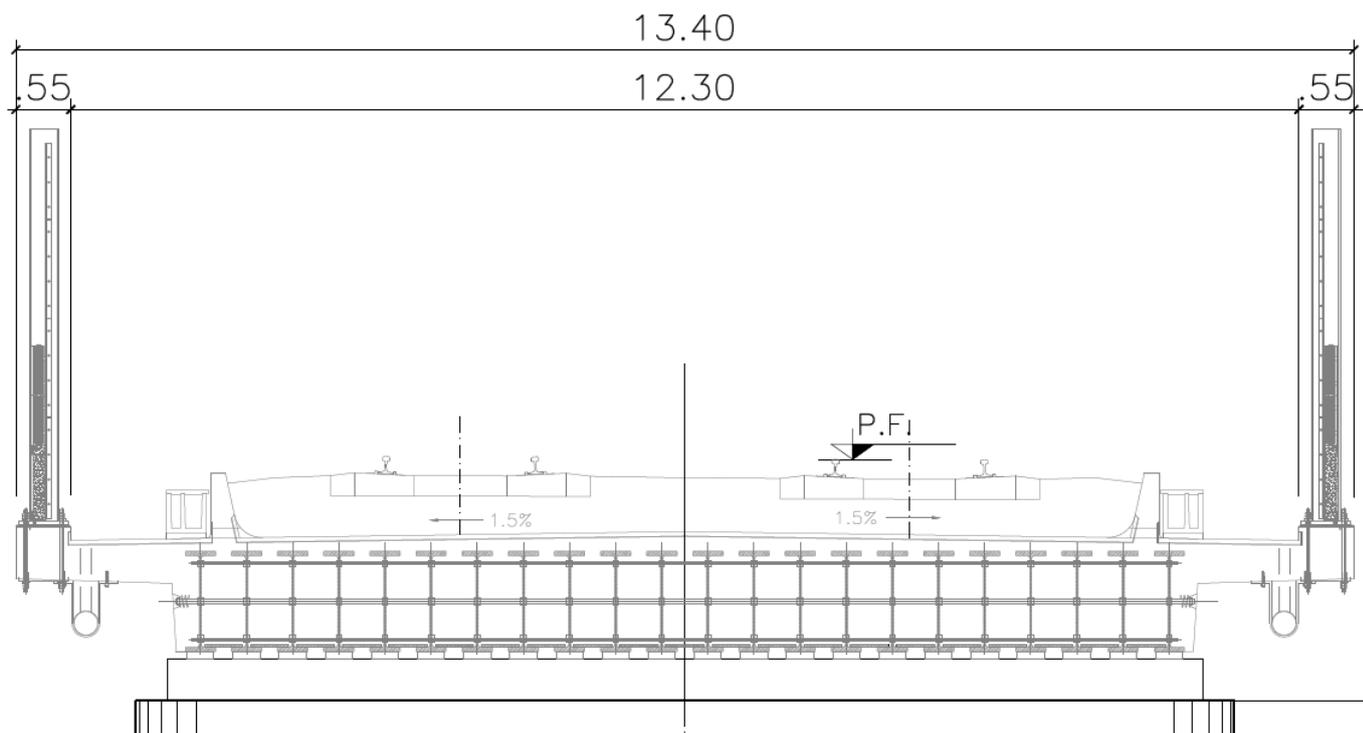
Sezione tipo - trasversale impalcato da 22 m con travi in acciaio incorporate.
